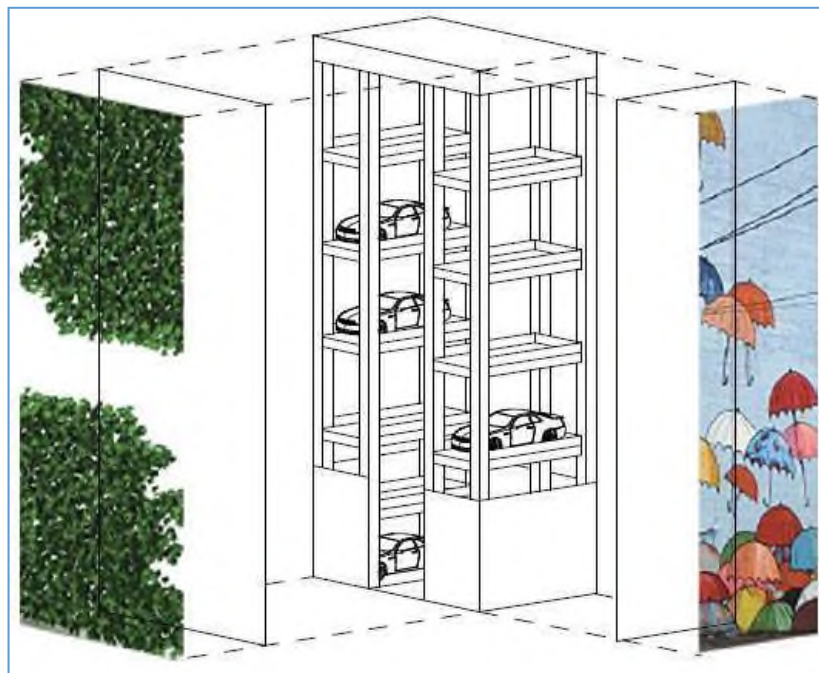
Exemplu de bună practică – propunere de animare a fațadelor structurilor de tip smart parking.
